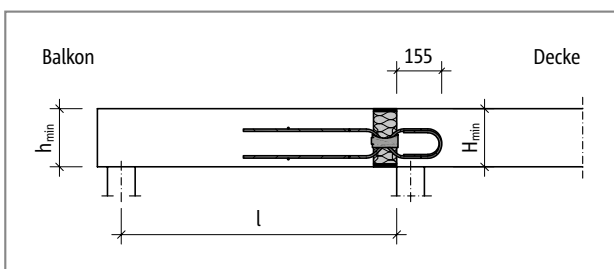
Schöck Isokorb® T Typ QL-VV1 bis Typ QL-VV3: Statisches System
